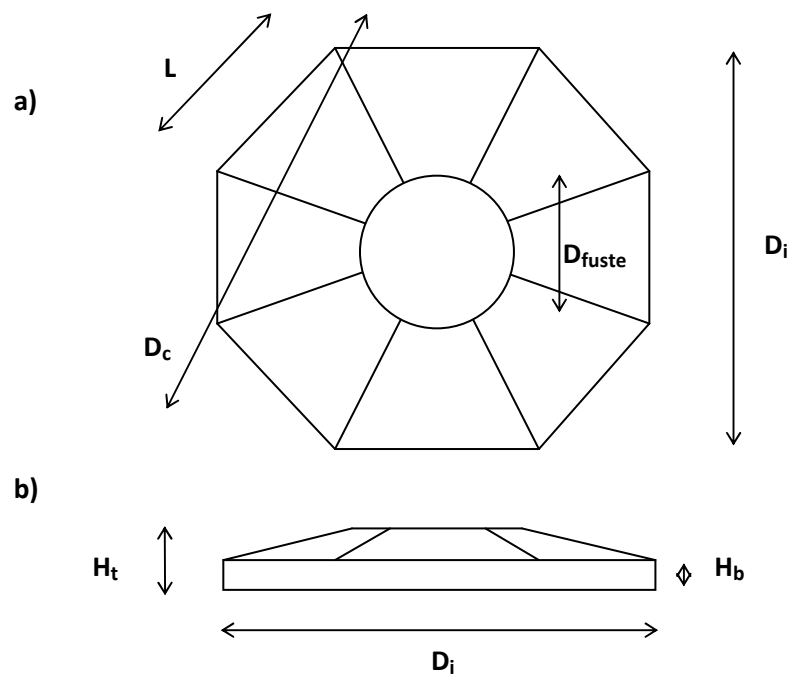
Zapata octogonal: a) vista en planta, b) vista en alzado.
